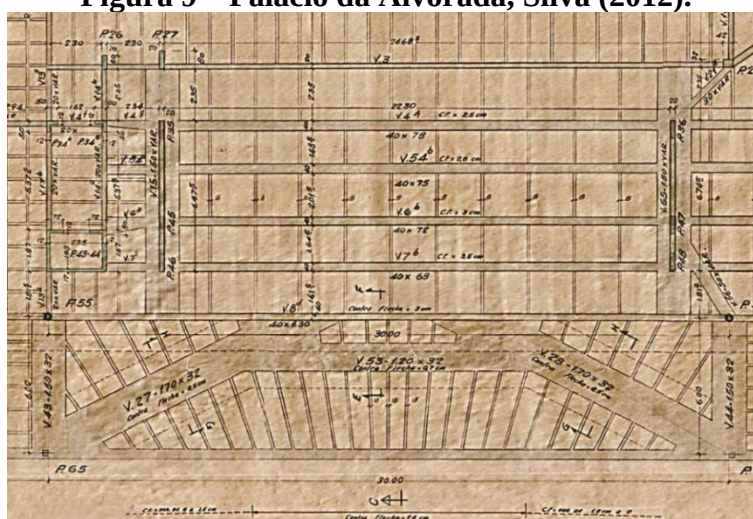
Planta de fôrmas do trecho de 30 metros de vão, Silva (2012).
